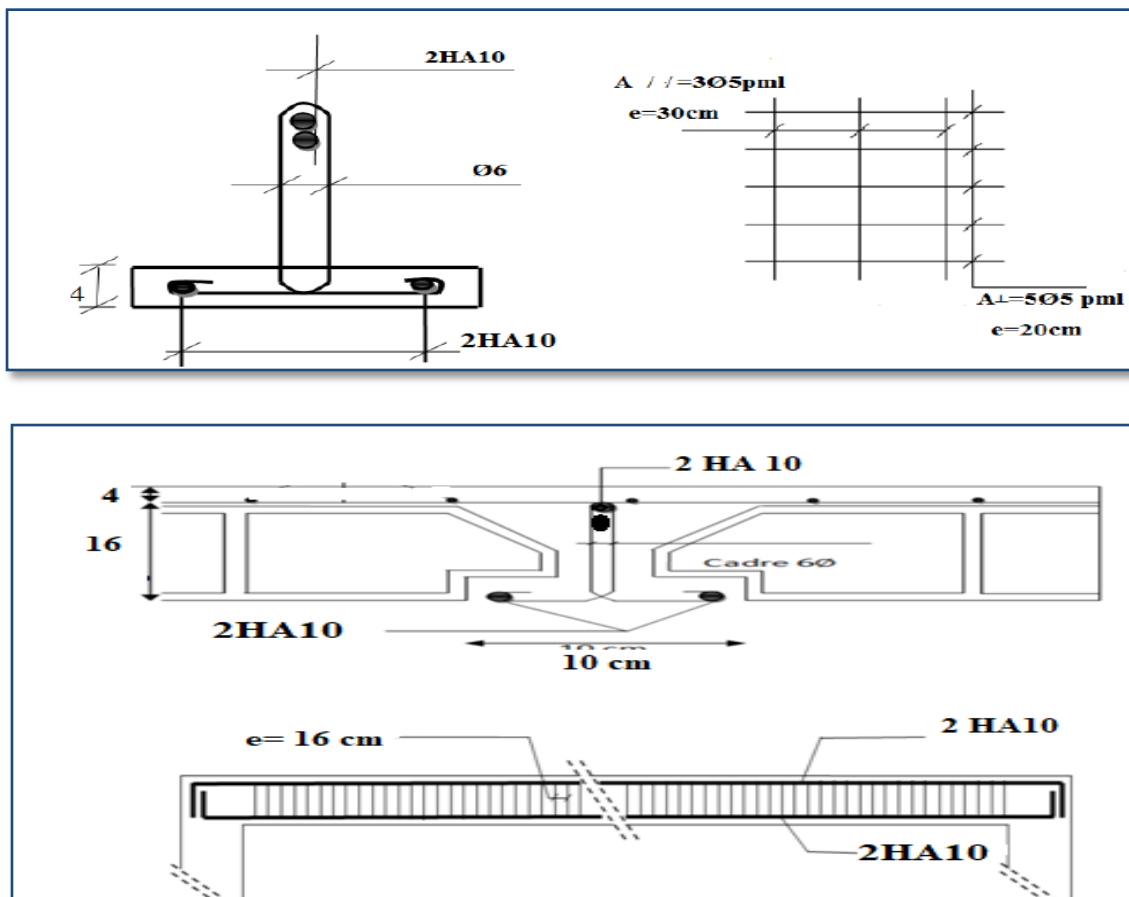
Ferrailage des plancher étage courant et terrasse.
